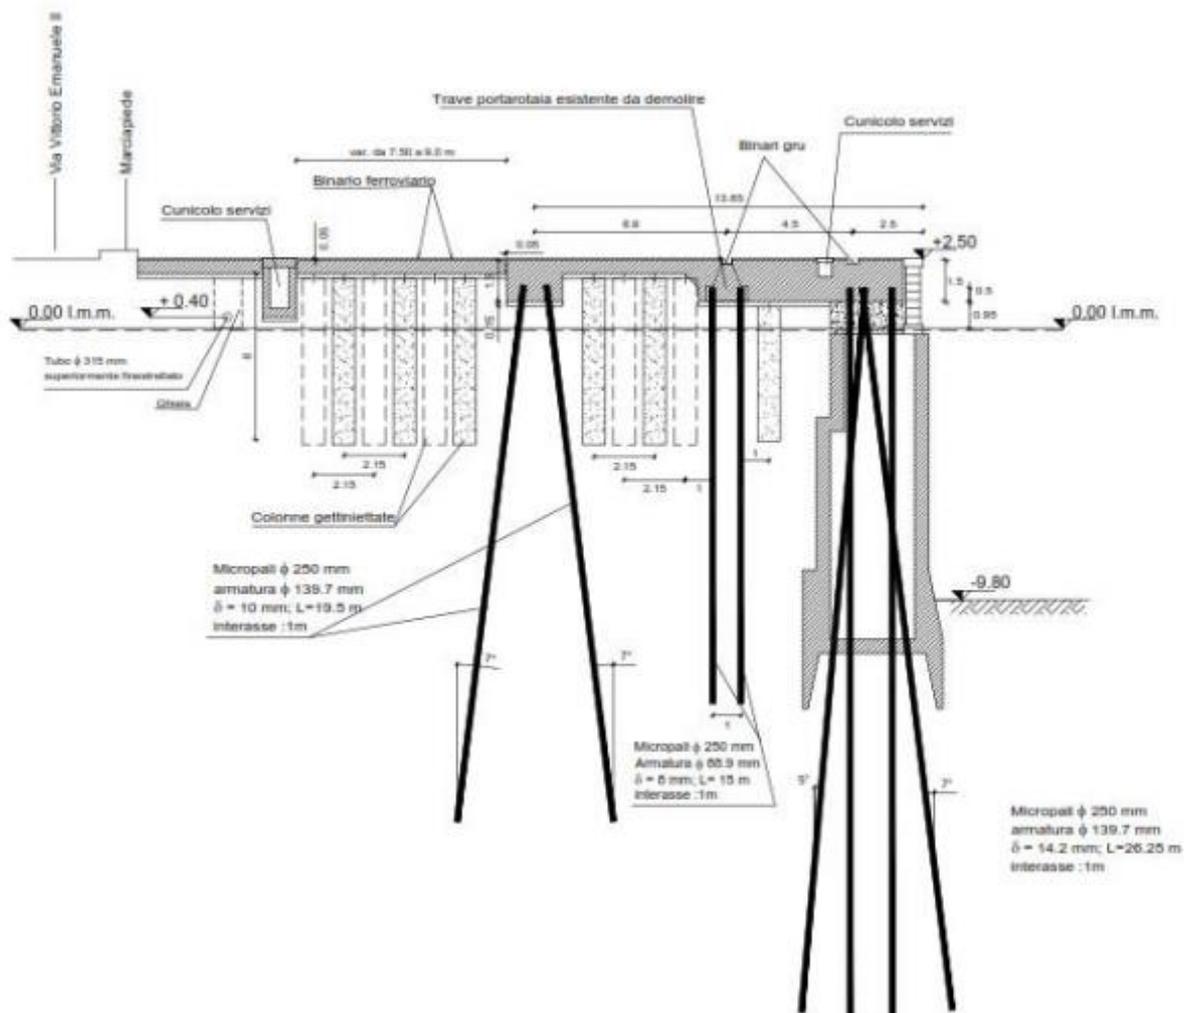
Sezione tipo banchina Peloro – Stato di fatto
